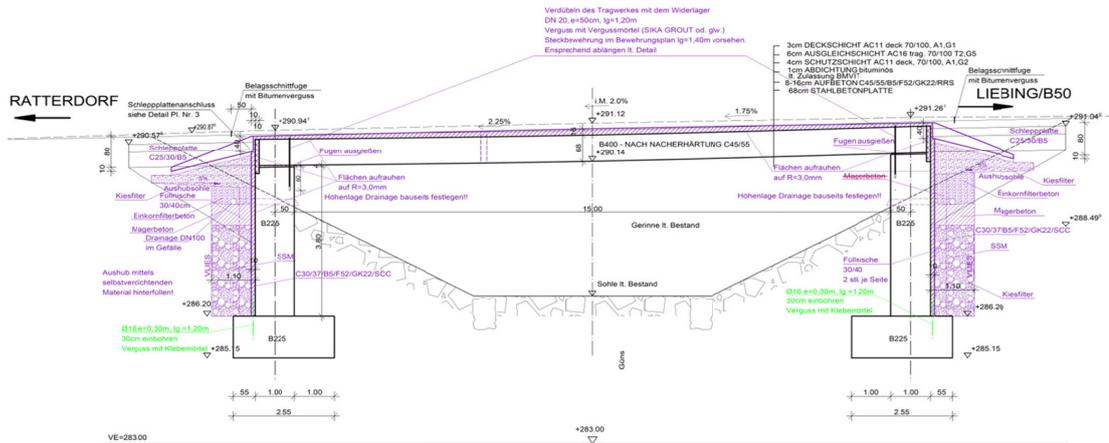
Längsschnitt Objekt 16021 [53]
